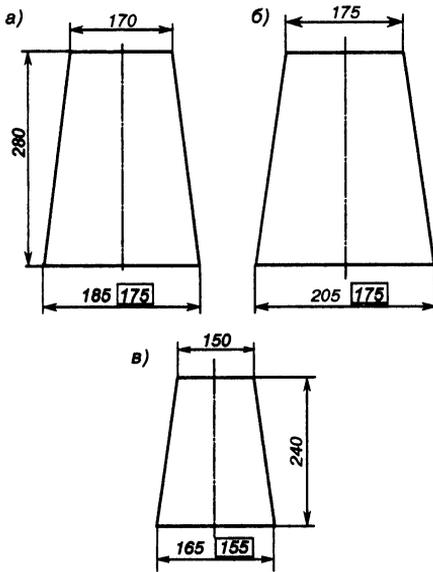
Сечения нижних оснований железобетонных опор (мм):
